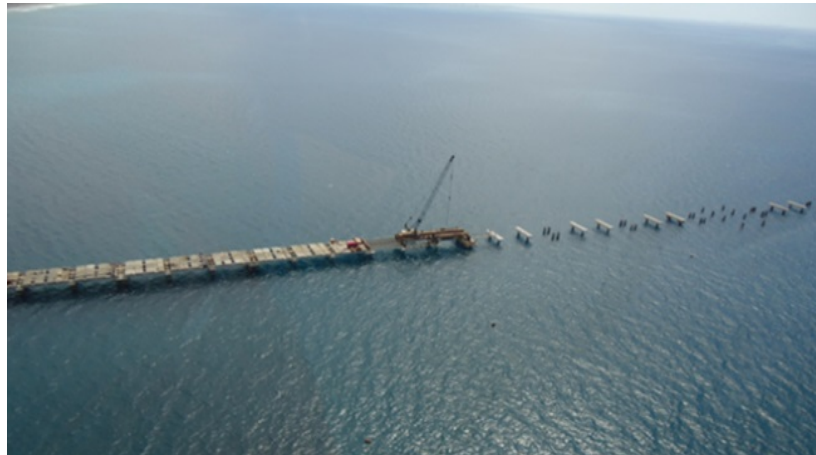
encofrado y fundición de canaletas en puente de acceso al muelle
